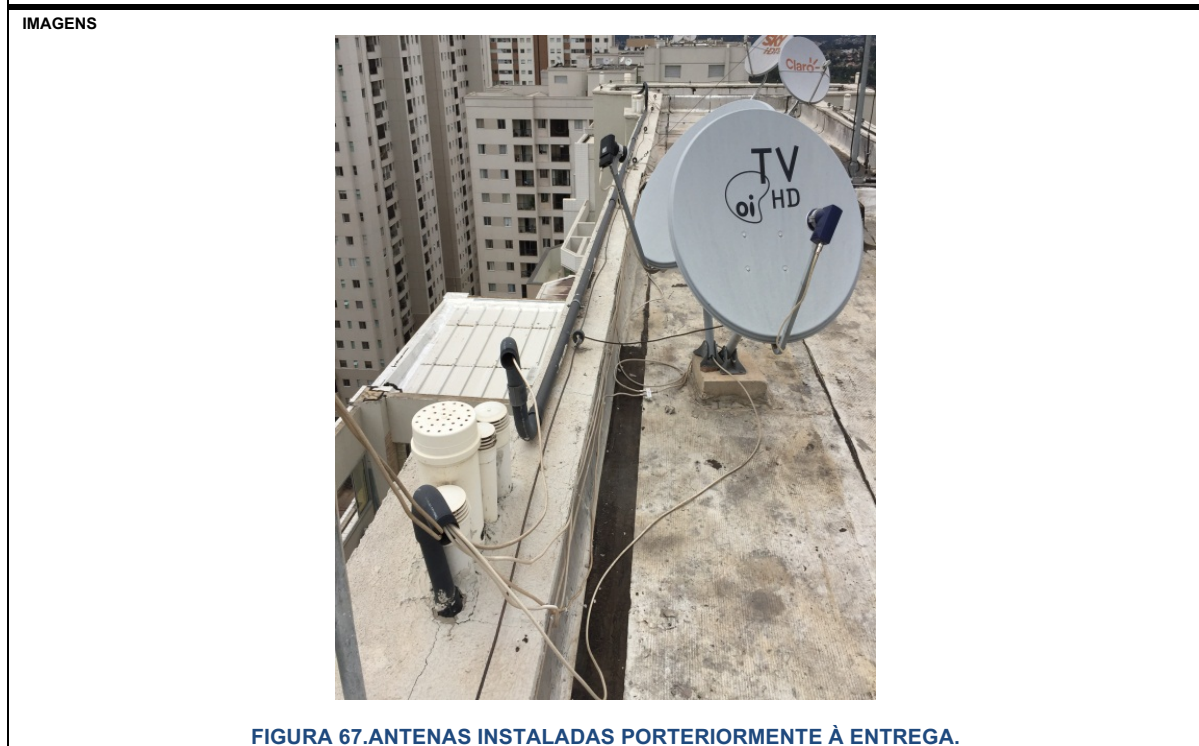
ANTENAS INSTALADAS POSTERIORMENTE.
